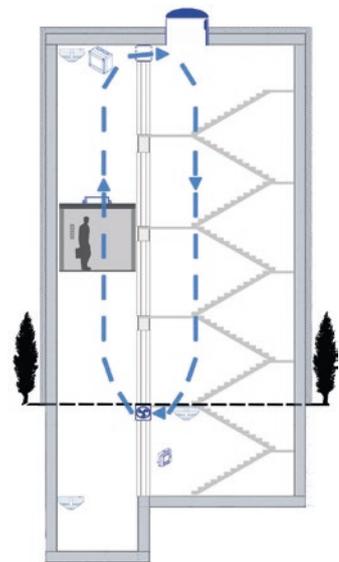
Lüftung im Aufzugsschacht bei Aufzugsstörung
